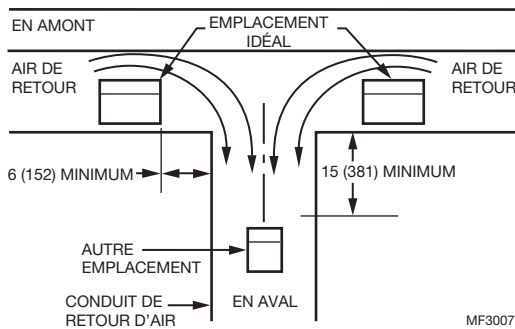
Montez l'interrupteur à ailette sur la ligne centrale du conduit dans l'une des positions en T indiquées pour les conduits de jonction.
